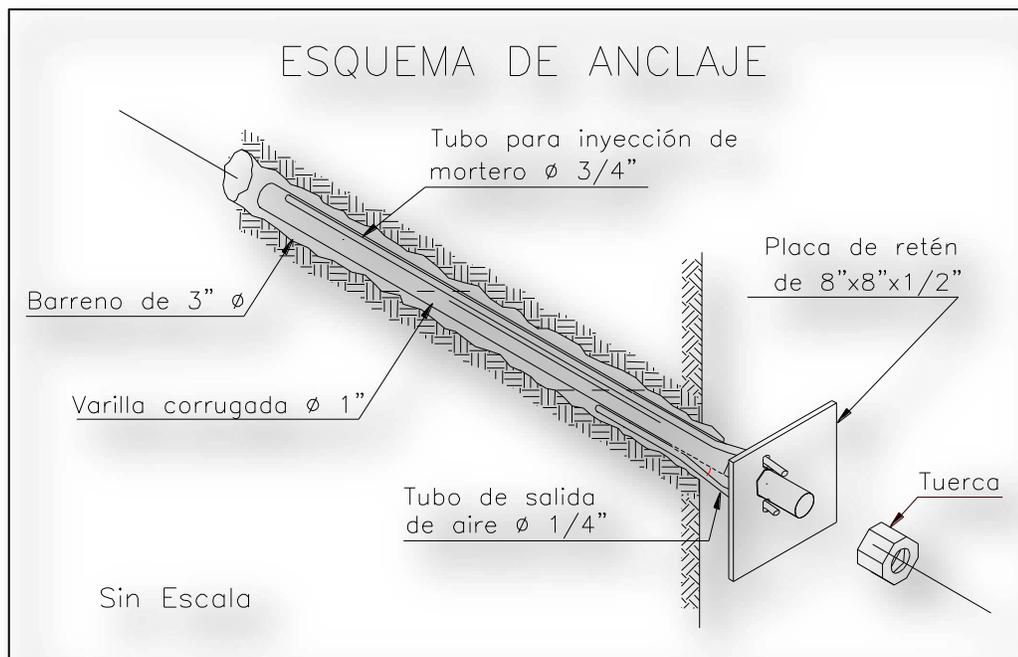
Esquema de anclaje. Fuente (proyecto ejecutivo).
